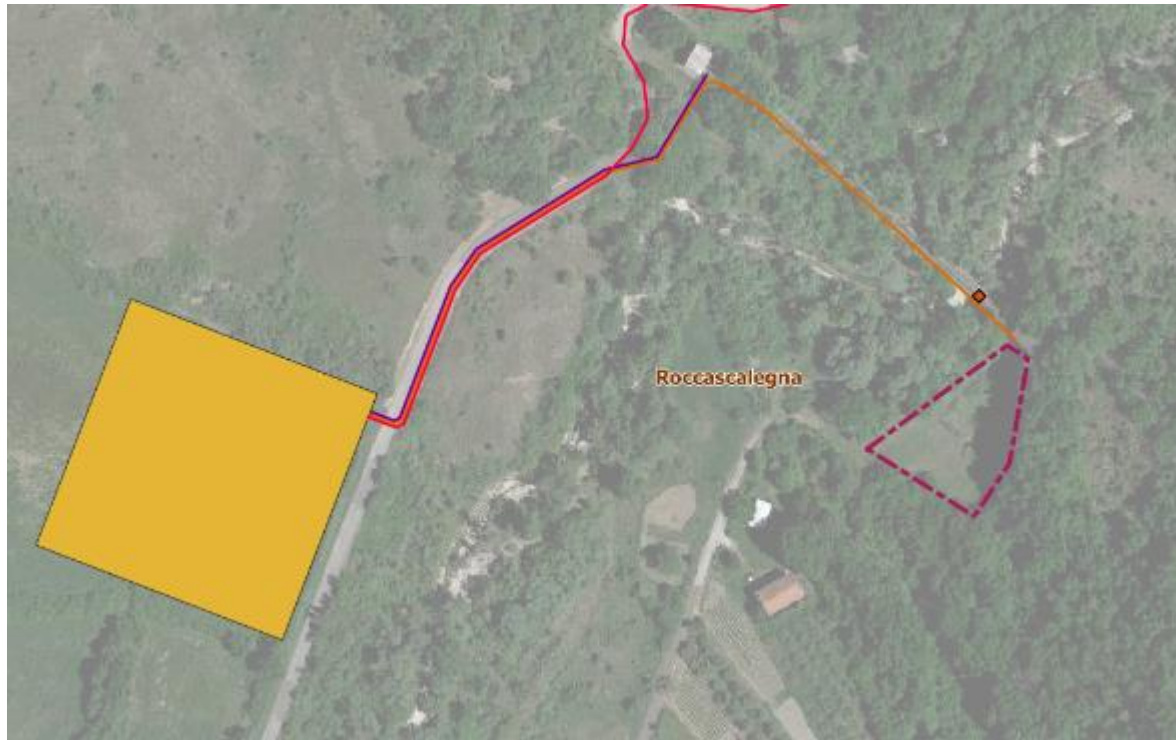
Localizzazione Cantieri Attraversamento - Stralcio 3
